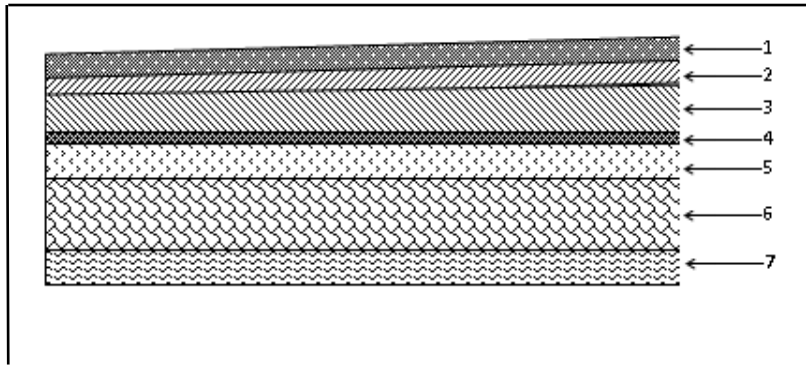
Coupe transversale du plancher terrasse inaccessible.
